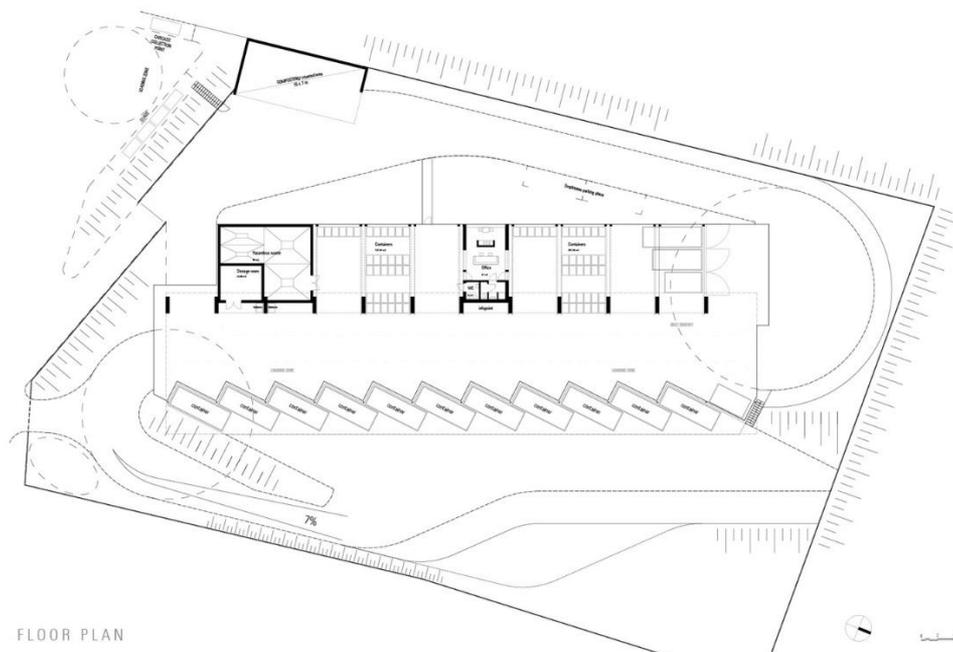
Planta baixa geral. (Fonte: <https://www.archdaily.com.br>)
